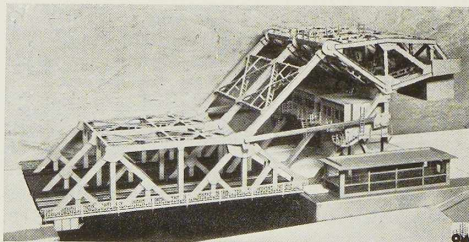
Maquette d'un pont basculant type Strauss construit à Anvers.
